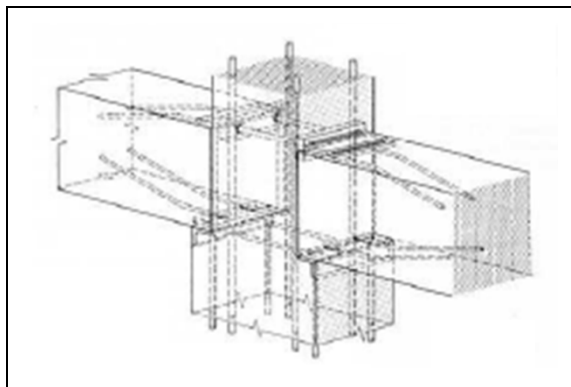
Ligação por chapas soldadas (Stupré, 1981)
